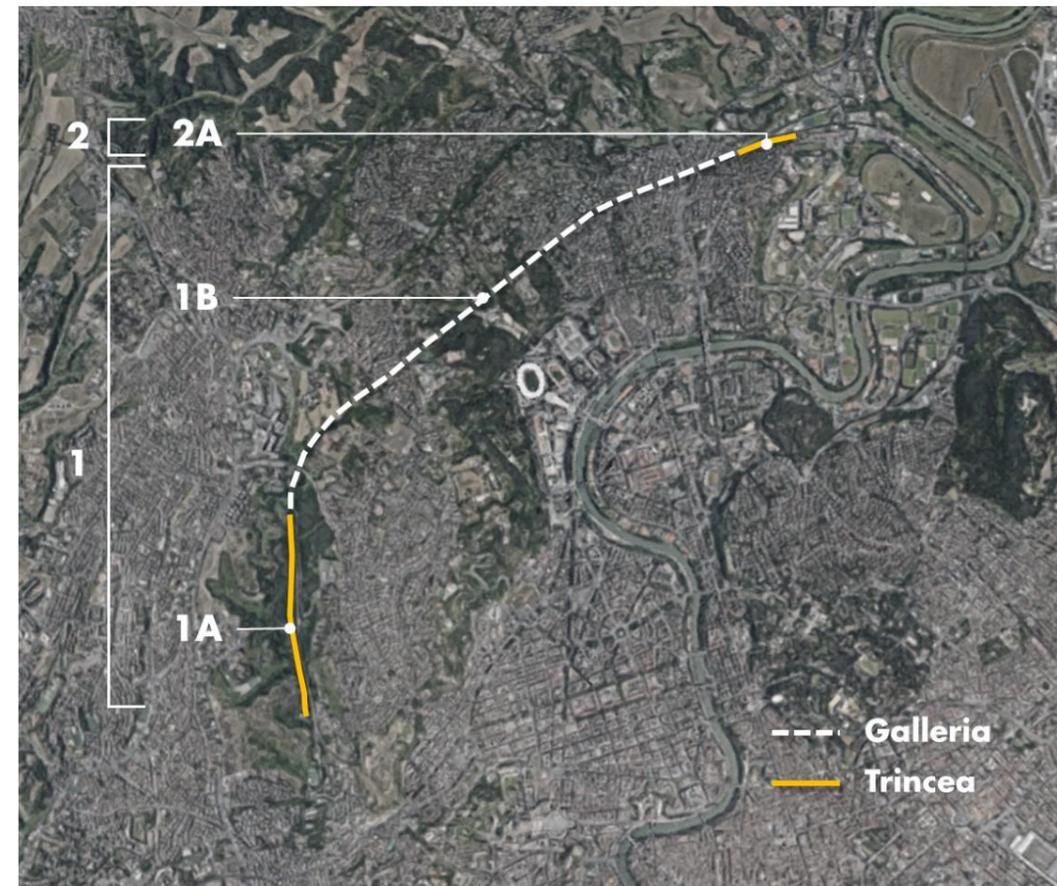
Tratta Valle Aurelia – Vigna Clara: Articolazione in parti rispetto alle tipologie infrastrutturali
